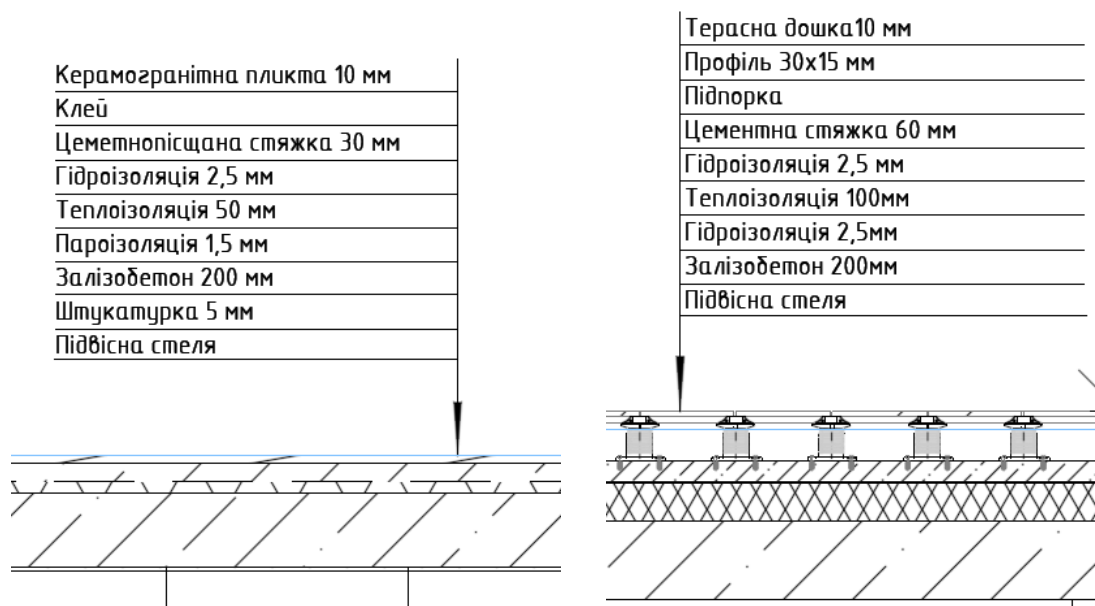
Конструктивне рішення перекриттів будівлі
